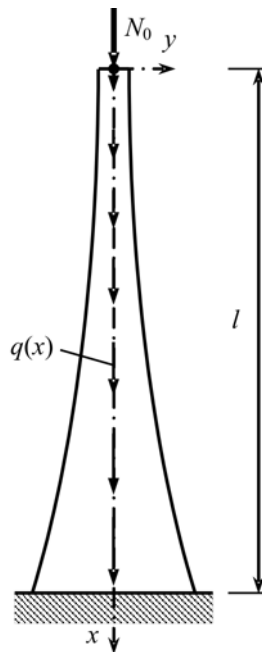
Расчетная схема весомого стержня с непрерывно изменяемым сечением
